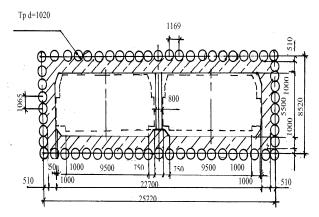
Схема тоннеля прямоугольного сечения с четырехполосным движением
